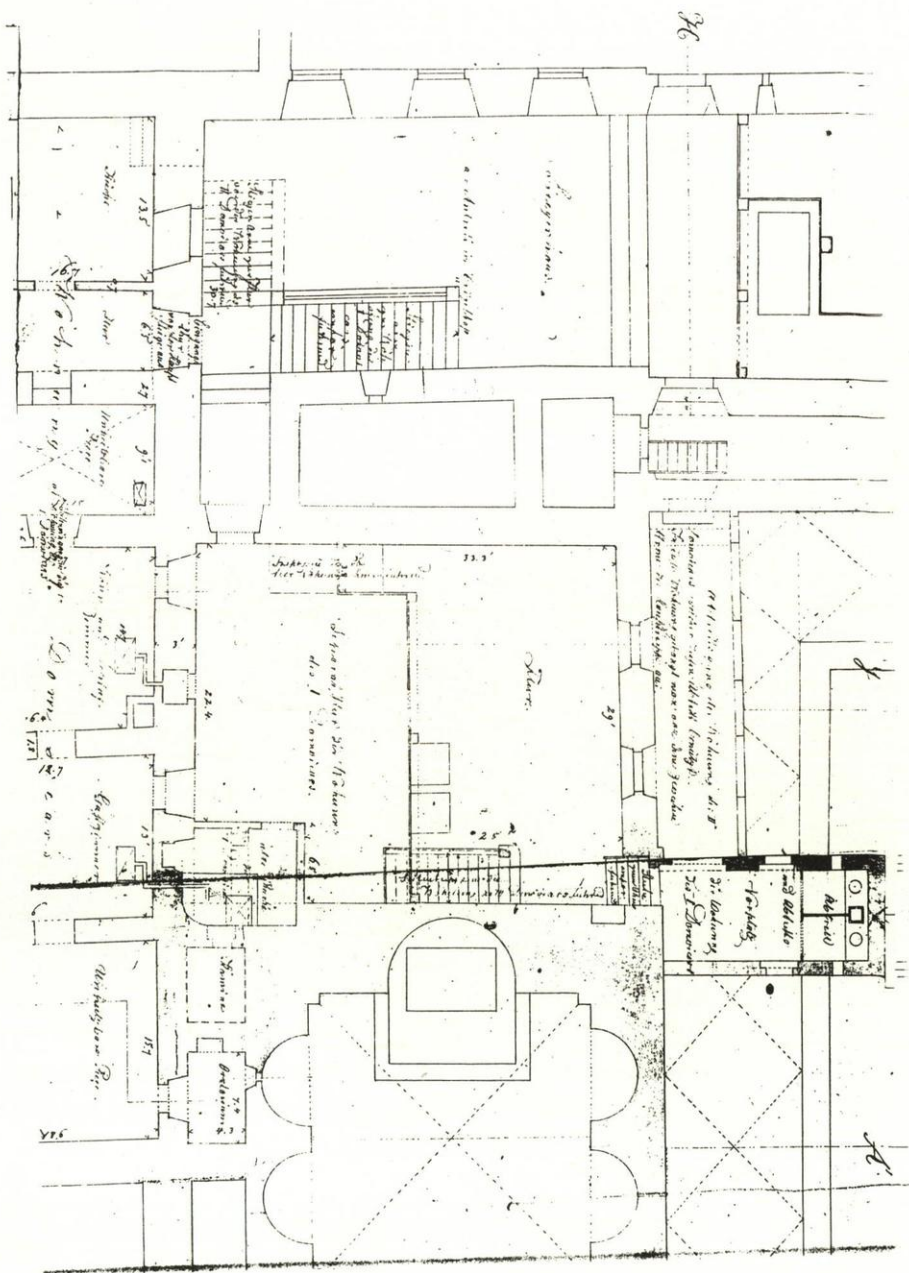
Grundriß des Quadermauerhauses im 1. Stock (Plan aus dem Akt „Unter den Schwibbögen 4“ im Landbauamt Regensburg, vermutlich 1860).
